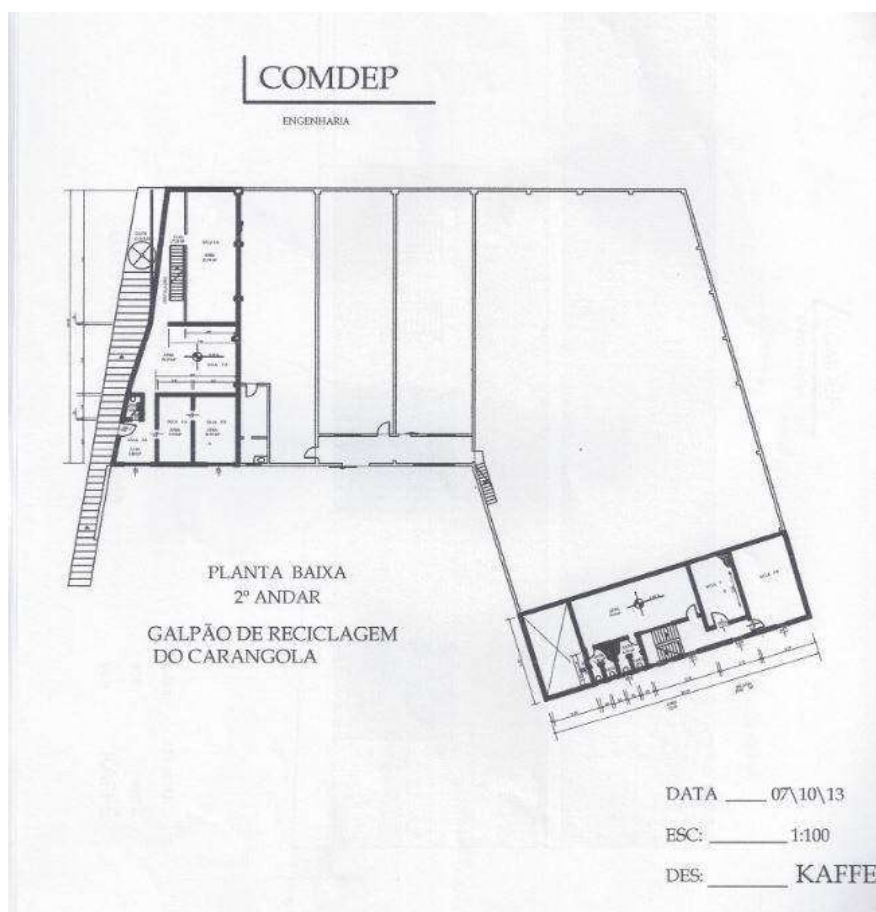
Planta Fachada – Galpão de Reciclagem do Carangola
